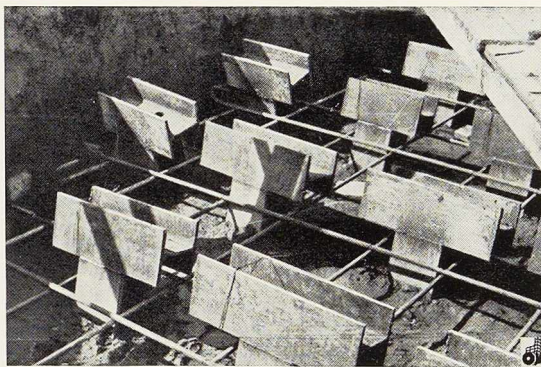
Têtes de pieux en poutrelles à larges ailes.
